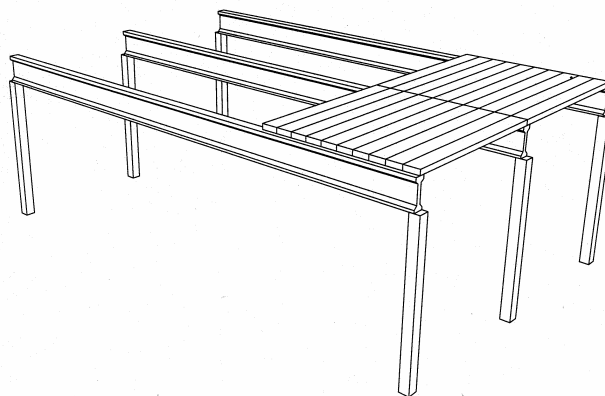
Traves planas apoiadas com vigas retas para cobertura.
